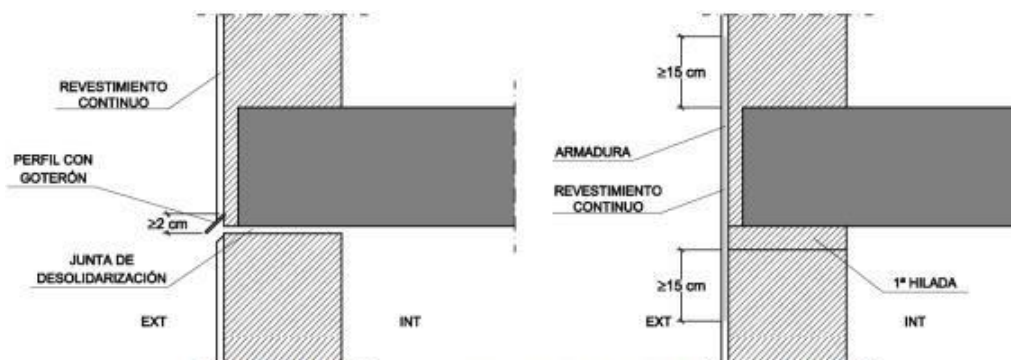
Ejemplos de encuentros de la fachada con los forjados
